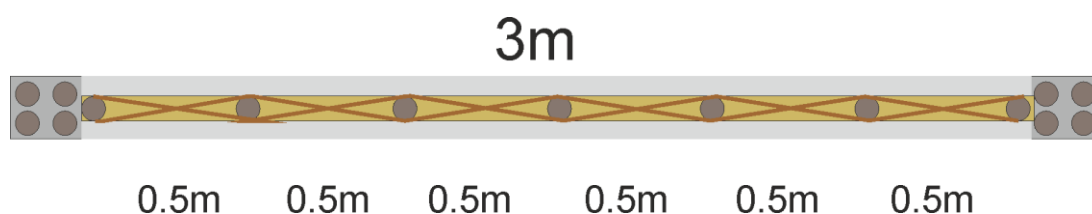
Muro de bahareque. Detalle de entramado. Vista en planta.
